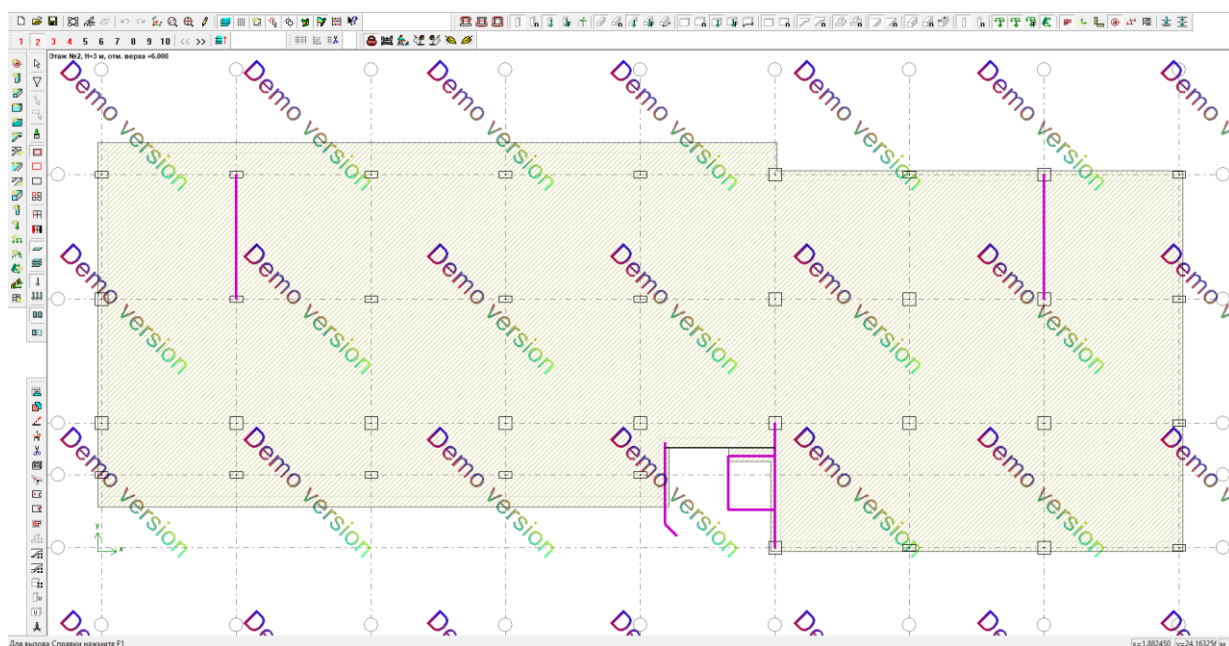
План компонування елементів конструкції типового поверху
